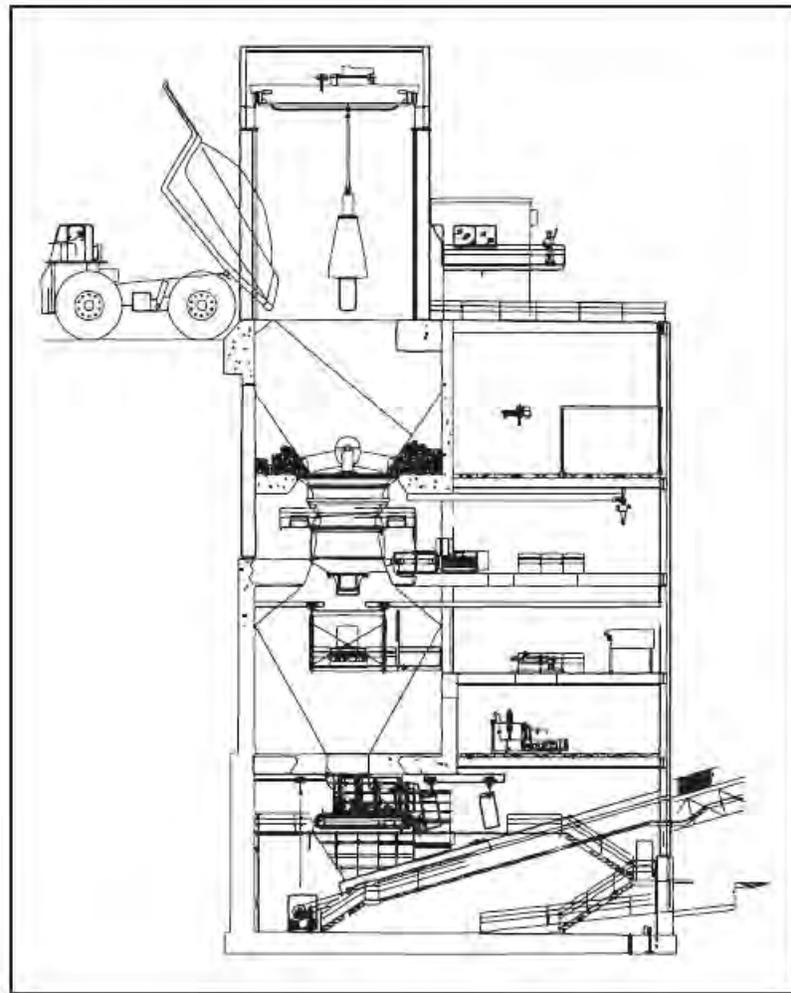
1 Chancadora fija montada en el borde instalada dentro de una estructura de concreto. Fuente: (Darling, 2011)
